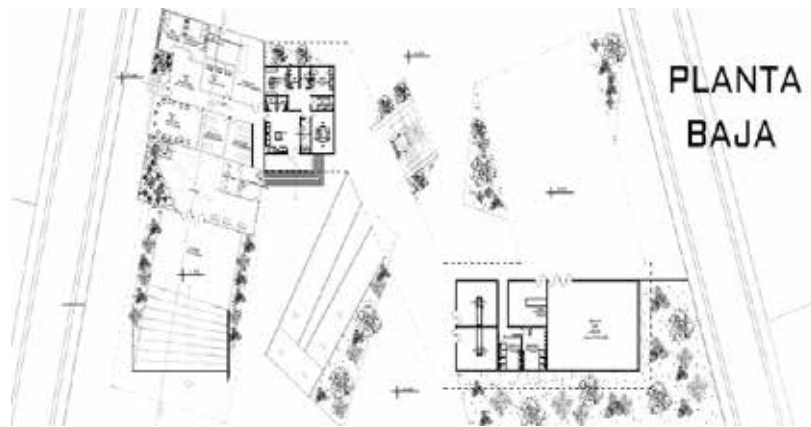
Planta baja conjunto del Centro de Artes Escénicas. Fuente: PDF. (2018)
